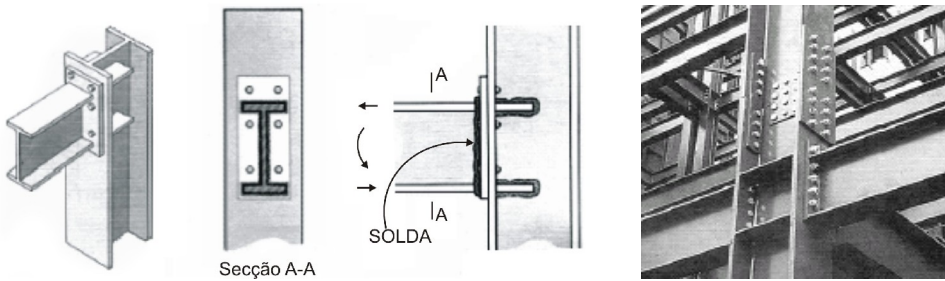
Exemplo de ligação rígida com chapa de extremidade parafusada para conexão entre viga e pilar.
